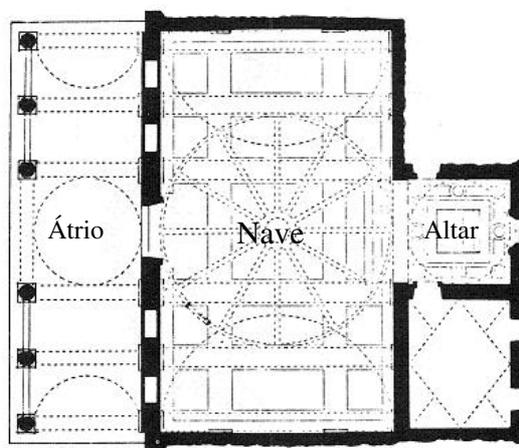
Planta Baixa da Capela Pazzi (séc. XV).
